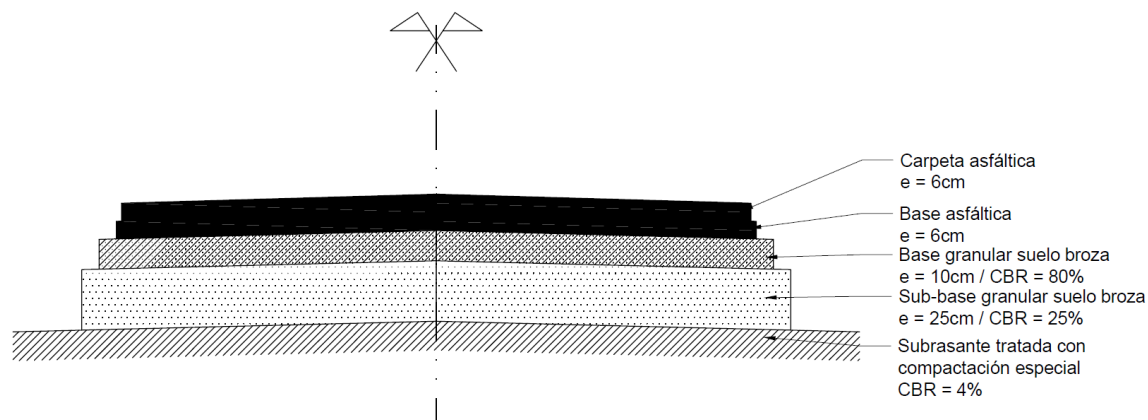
Paquete estructural del pavimento. Fuente: elaboración propia.
